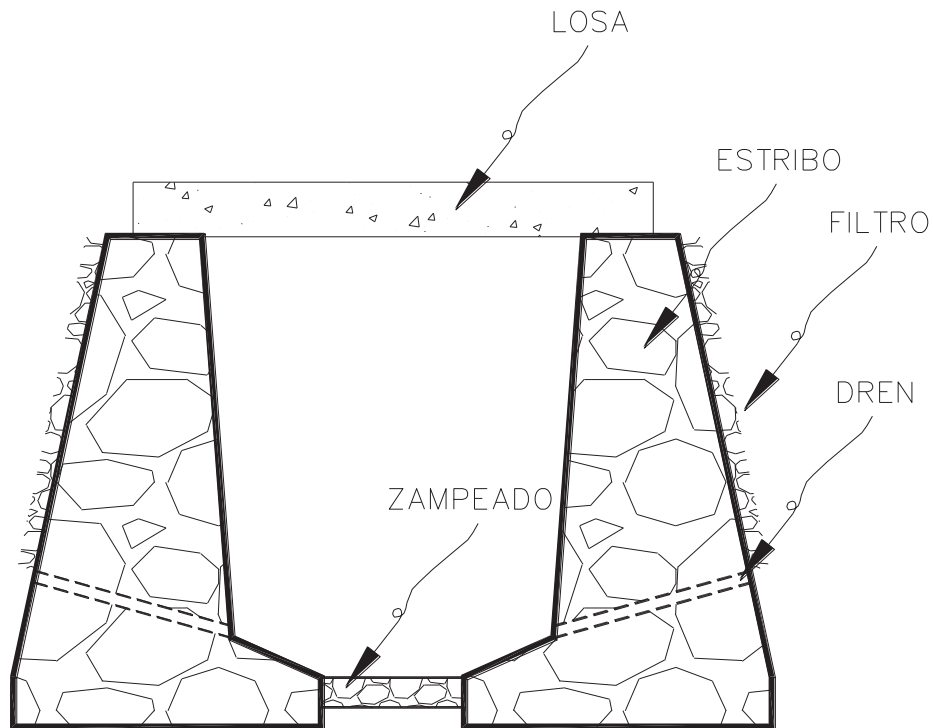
Alcantarilla de losa (Corte transversal).
